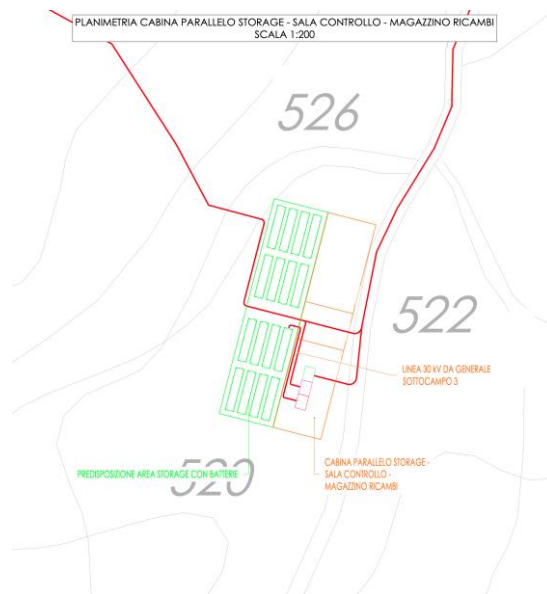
planimetria cabina parallelo Storage, Sala controllo e Magazzino ricambi - variante progettuale
